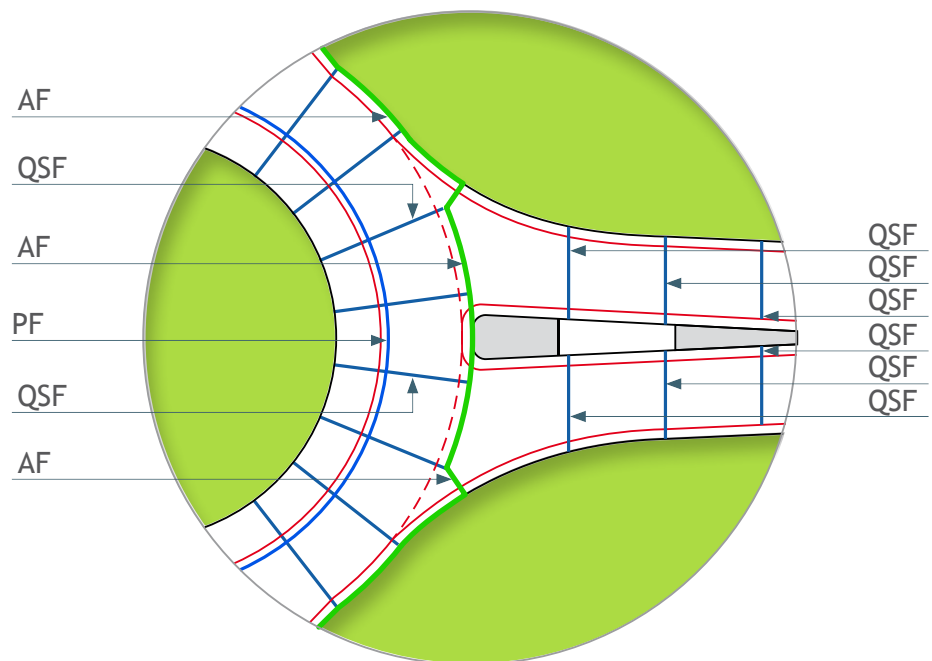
pavimentazione CRCP all'innesto dei bracci di ingresso e uscita.
